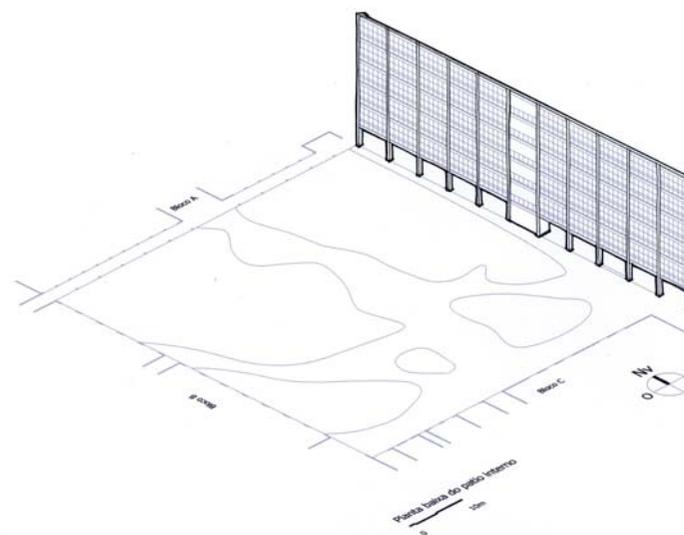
Estudo dos planos verticais, fachada Leste do pátio interno do CEFET.
